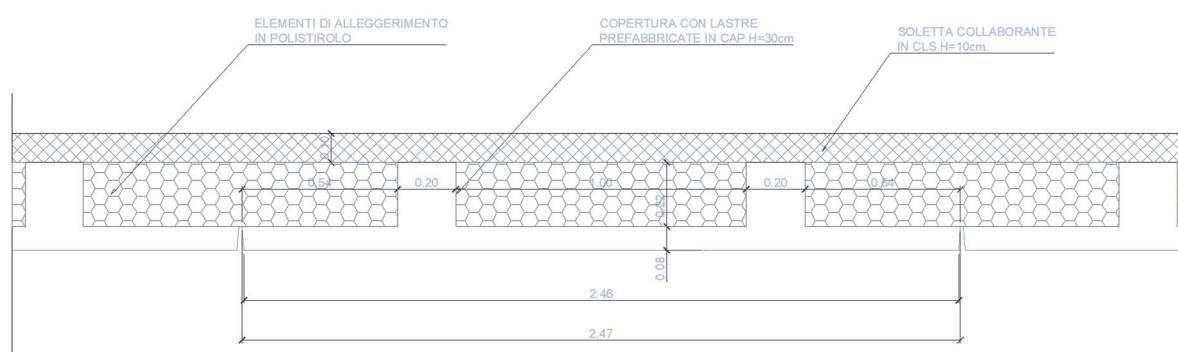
SEZIONE TIPO SOLAIO DI COPERTURA
